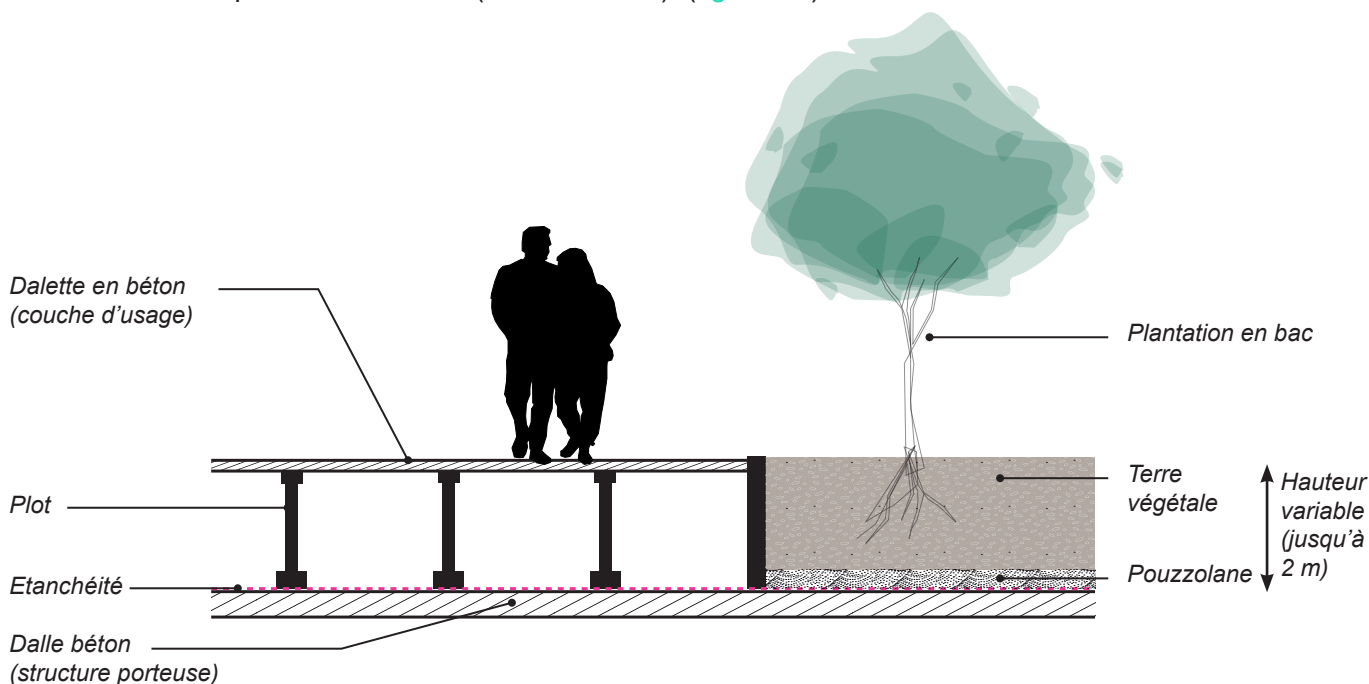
Structure d'une dalle sur plot (Source : Le Saout, 2016)
